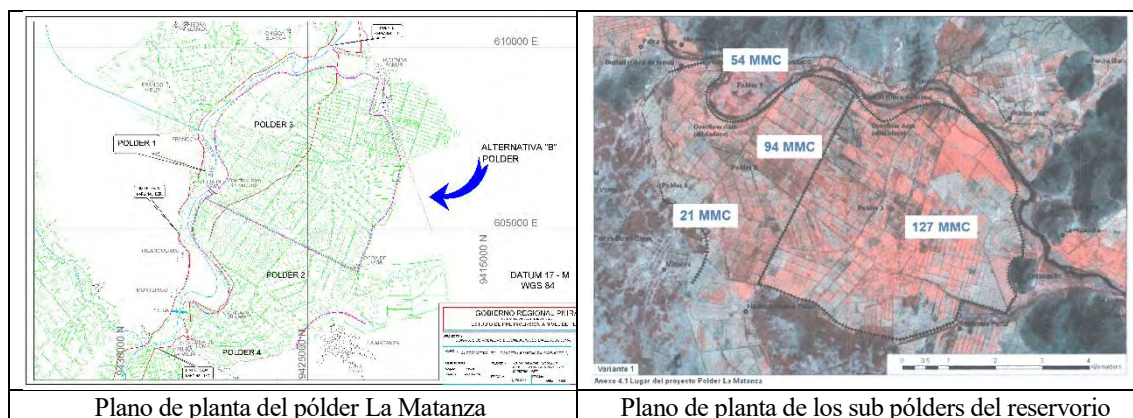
Plan de construcción del Pólder La Matanza
